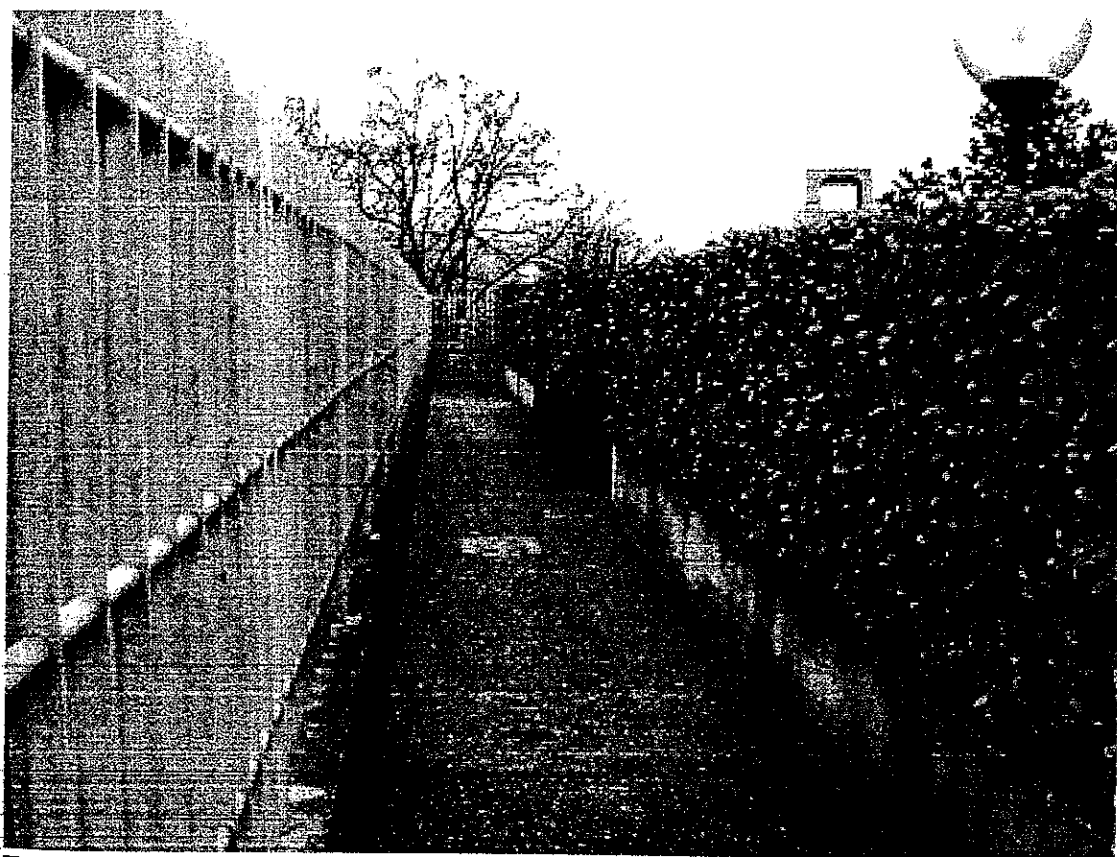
Vista verso sud della parte terminale del vialetto d'accesso comune.
